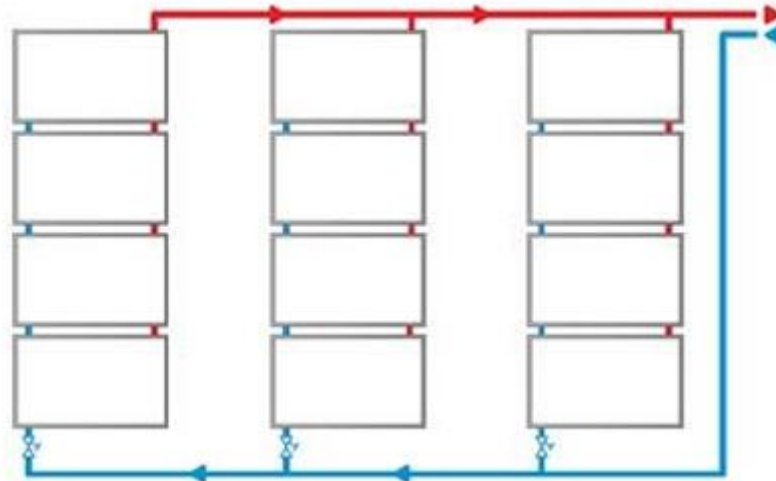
Esquema de baterías de paneles conectadas en válvulas de equilibrado hidráulico.
